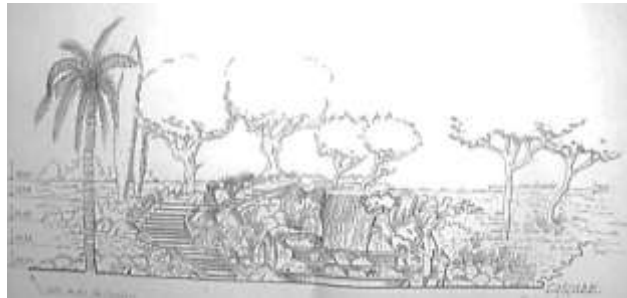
Cascade du jardin méditerranéen (coupe façade, Ech : 1/50)
